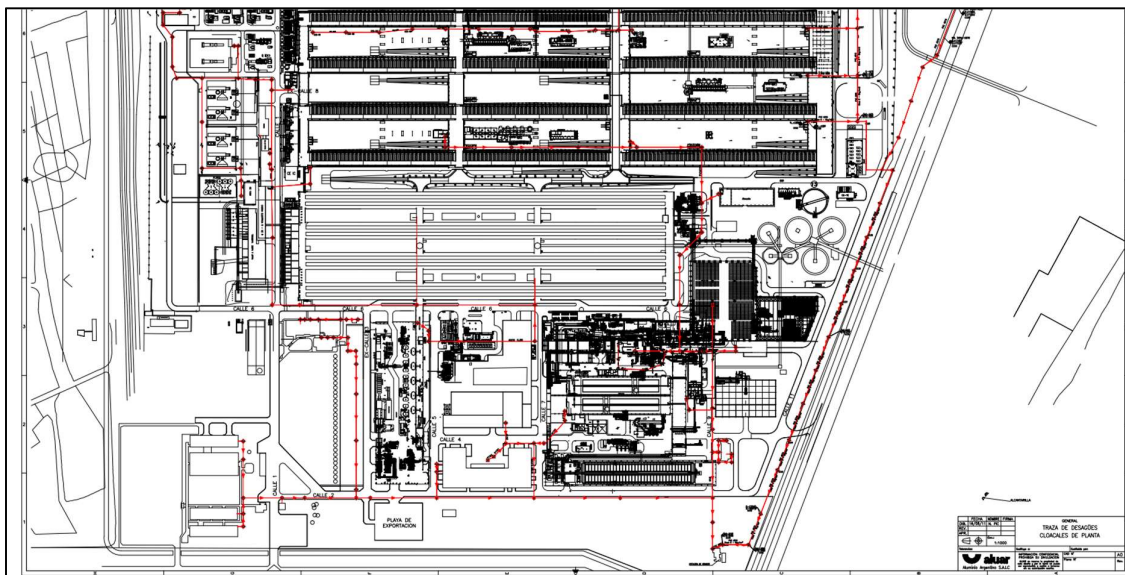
Parte del Plano de la Taza de Desagües cloacales de Planta en el que se observa su descarga a la Planta de Tratamiento de Cloacales Primario.
